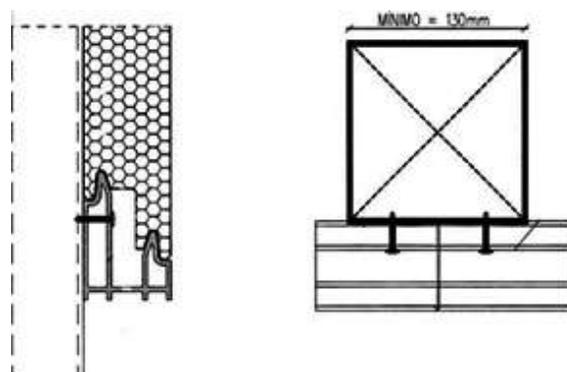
Detalhe de fixação e emendas de apoio suspensos. (DÂNICA, 2013a)
